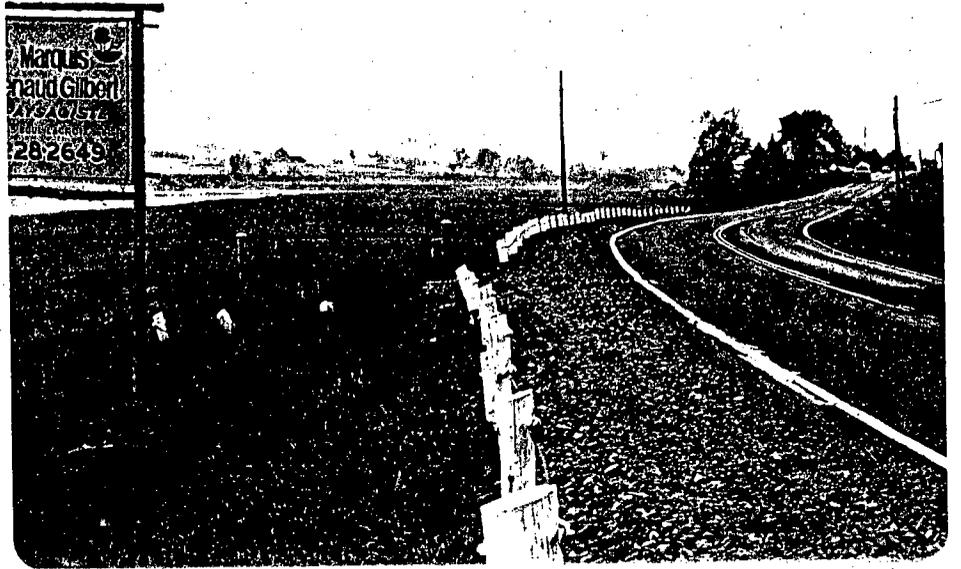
Route 173, vers Notre-Dame-des-Pins. Fin des murs de soutènement.
